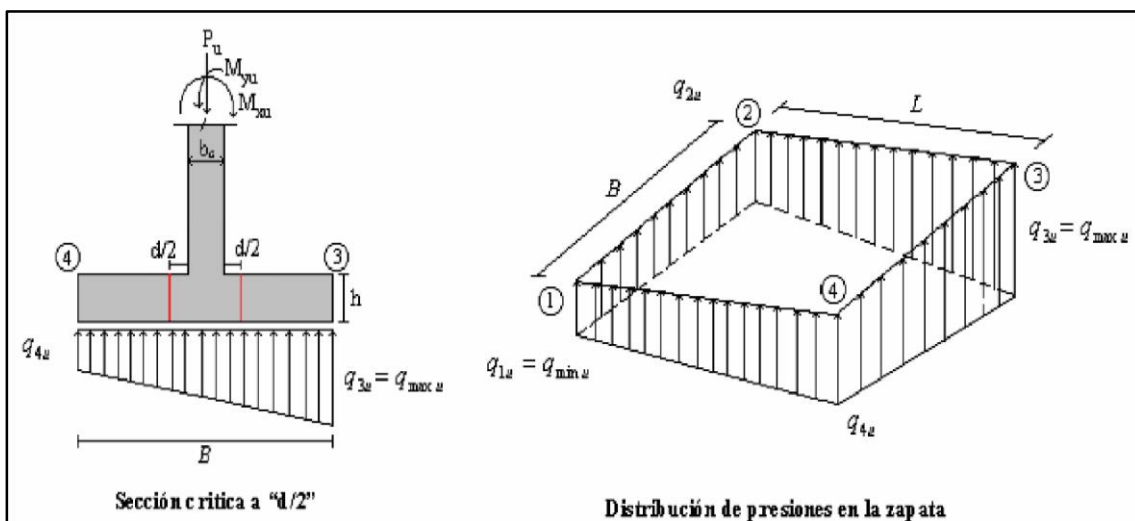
Distribución de presiones en la zapata Fuente: Luis Garza [13].
